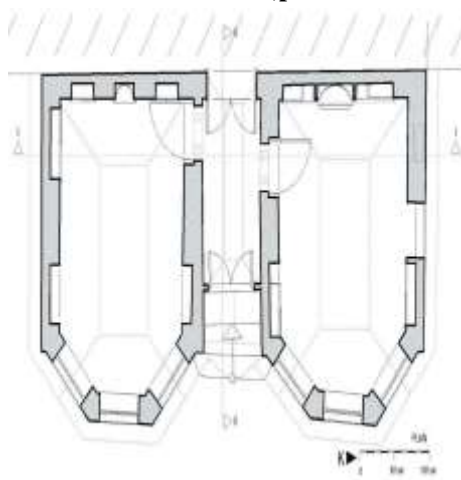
كلية عتيق علي باشا- مسقط أفقي
